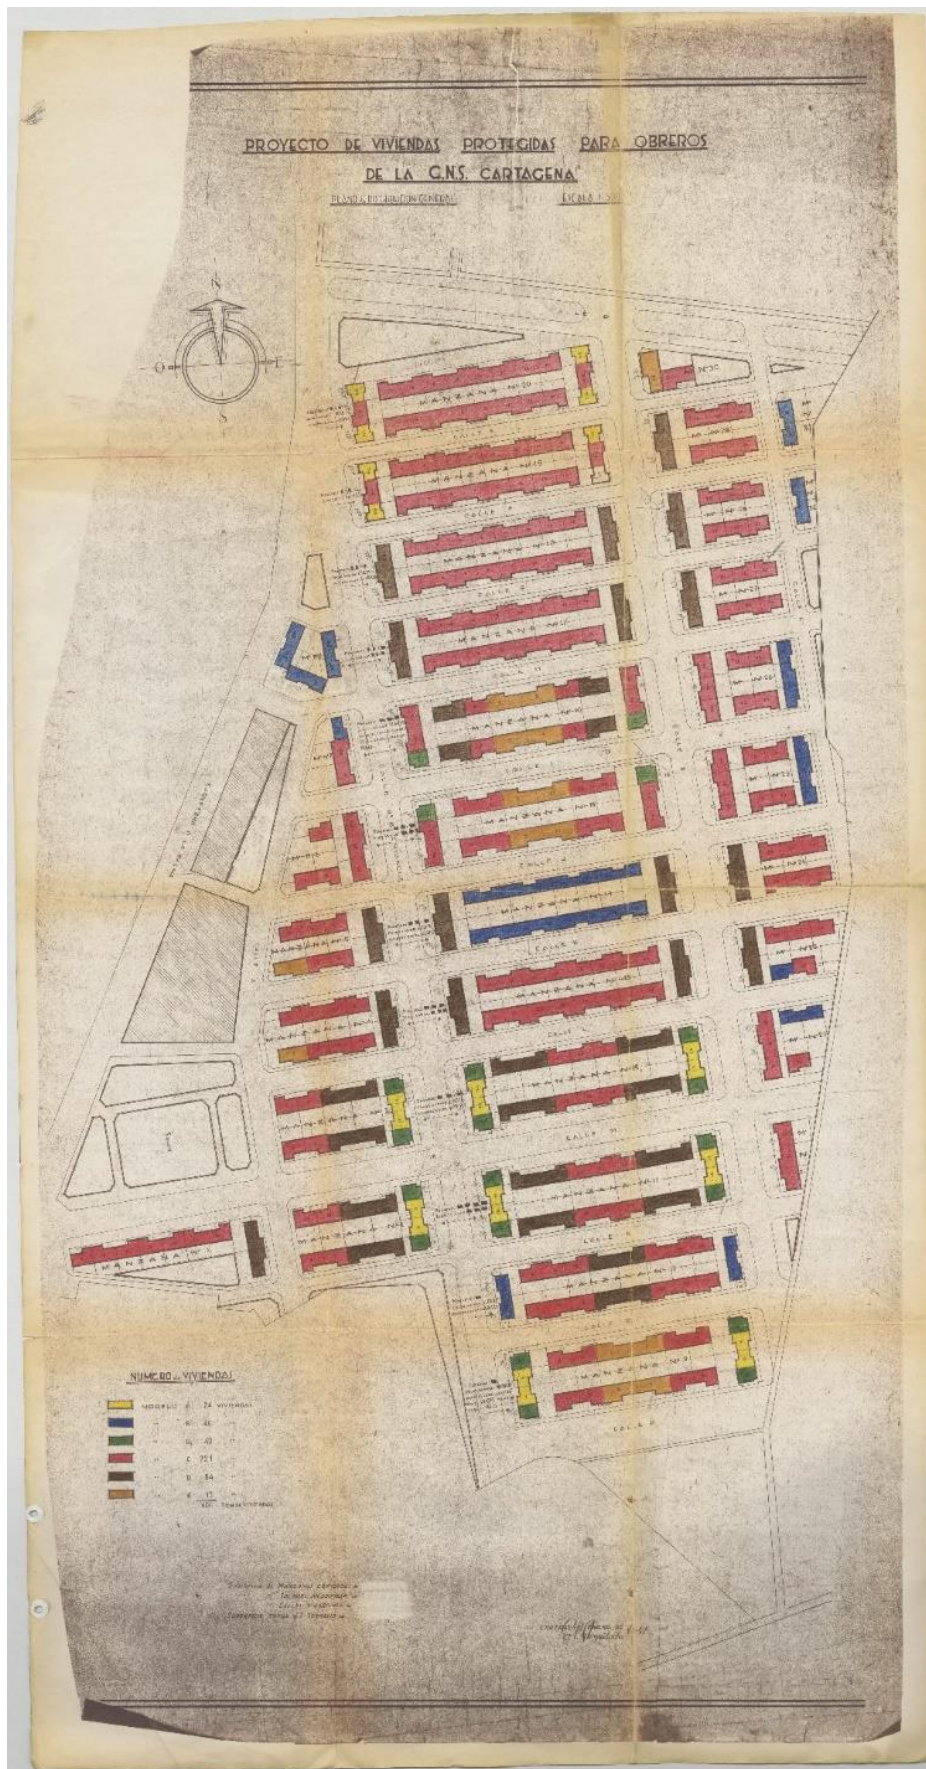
Plano de distribución de las viviendas. [Fuente: Archivo General de la Región de Murcia]
